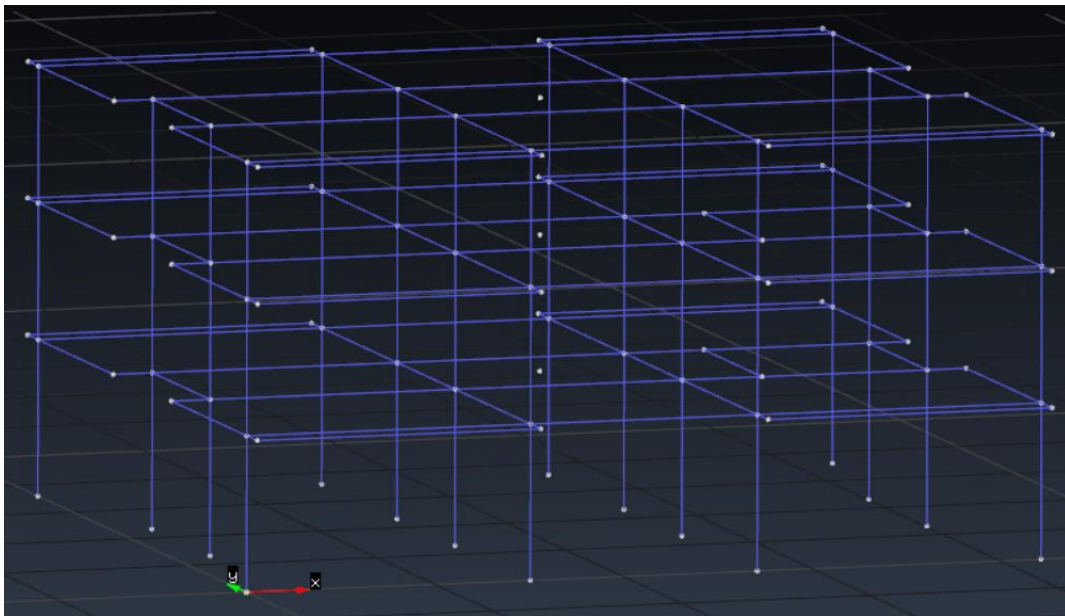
Modelo geométrico de la estructura, formada por nodos, pilares y vigas (Fuente: GiD).
